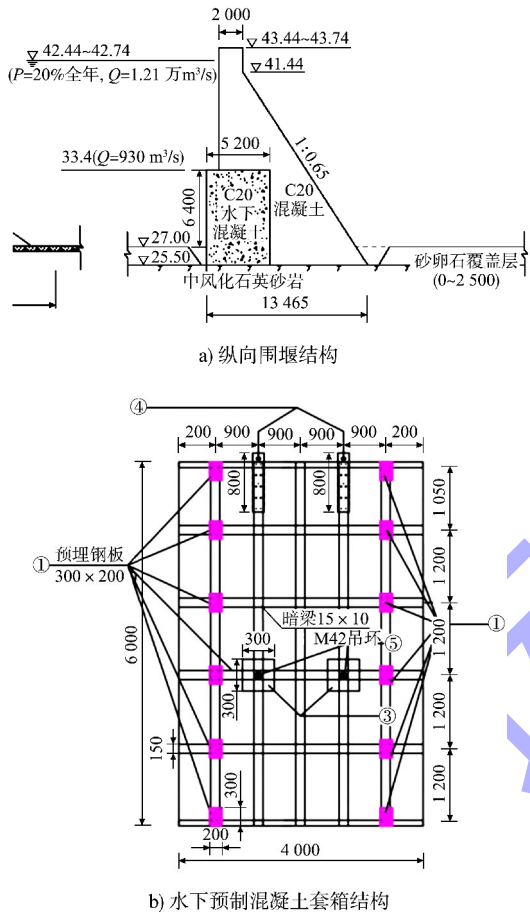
预制混凝土套箱纵向围堰结构布置 (尺寸:mm;高程:m)
